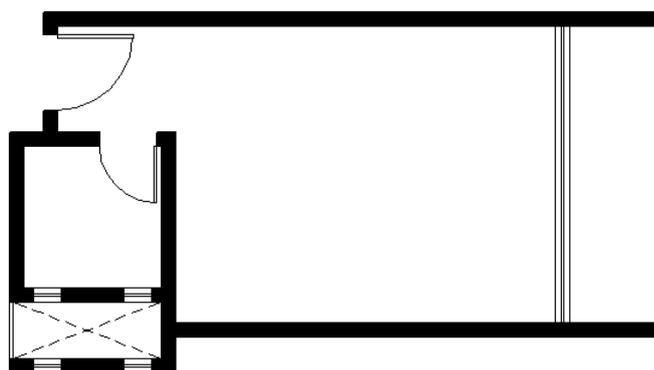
Planta Baixa da Quitinete B13 (Uso de Duto Vertical de Luz)
